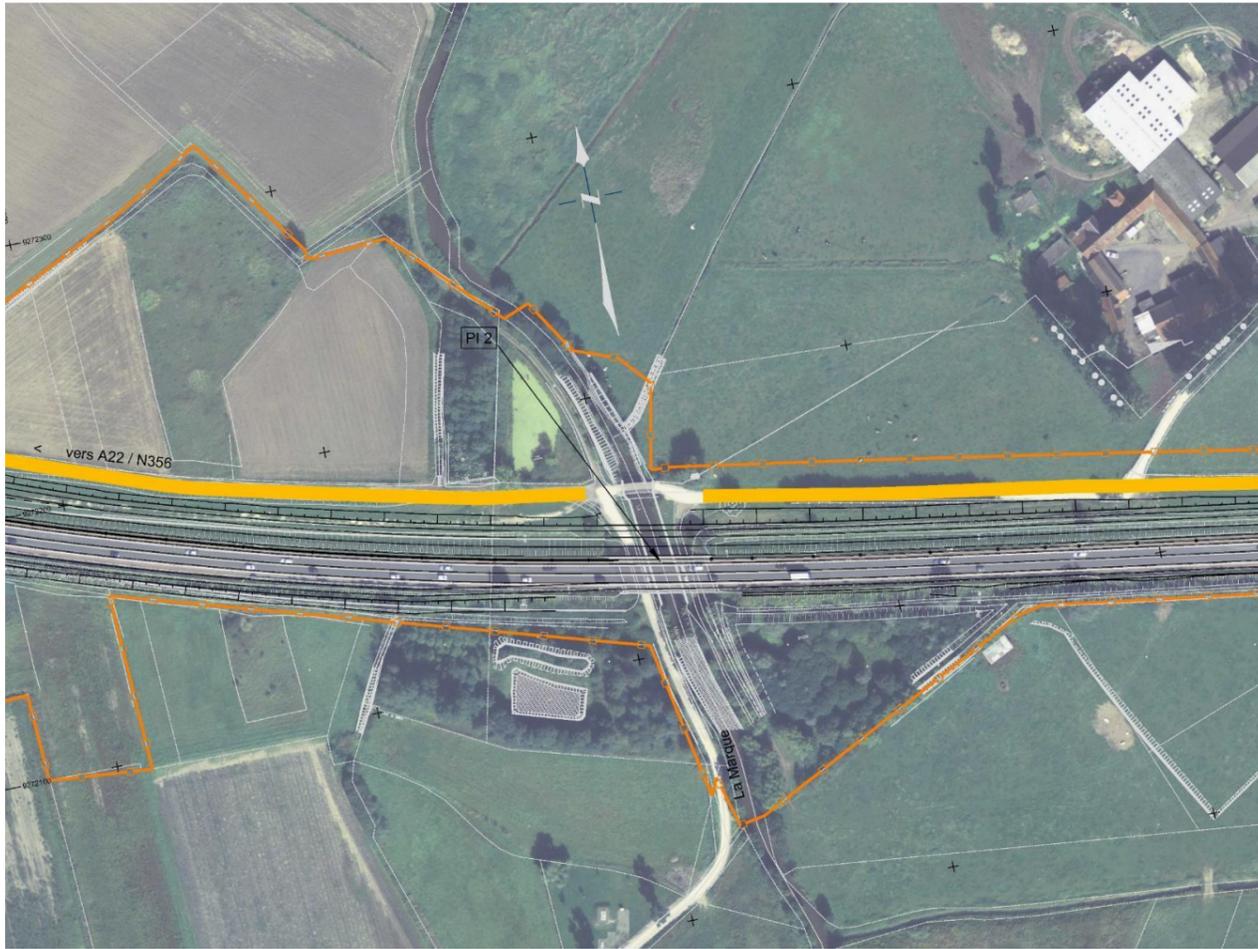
Zoom sur le projet au droit de la Marque et du boisement
